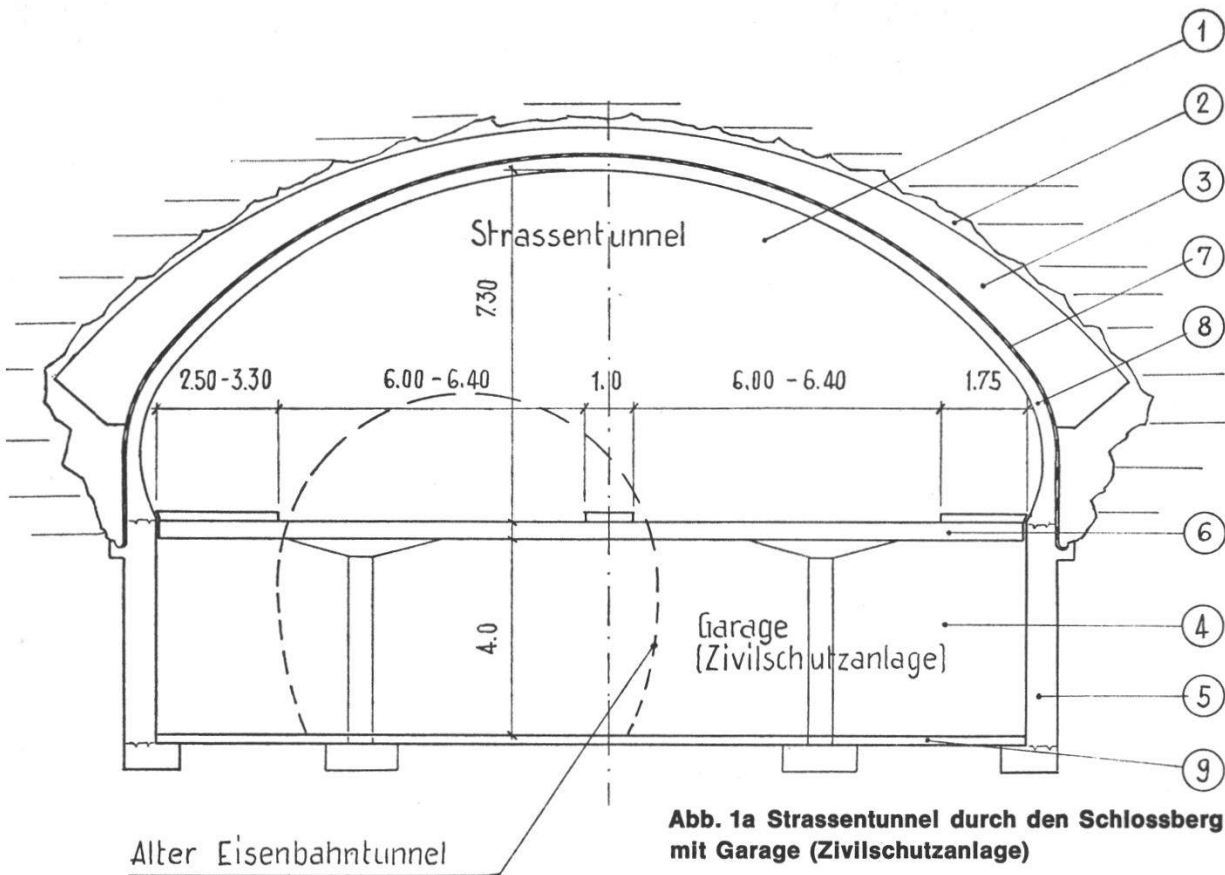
Strassentunnel durch den Schlossberg mit Garage (Zivilschutzanlage)
